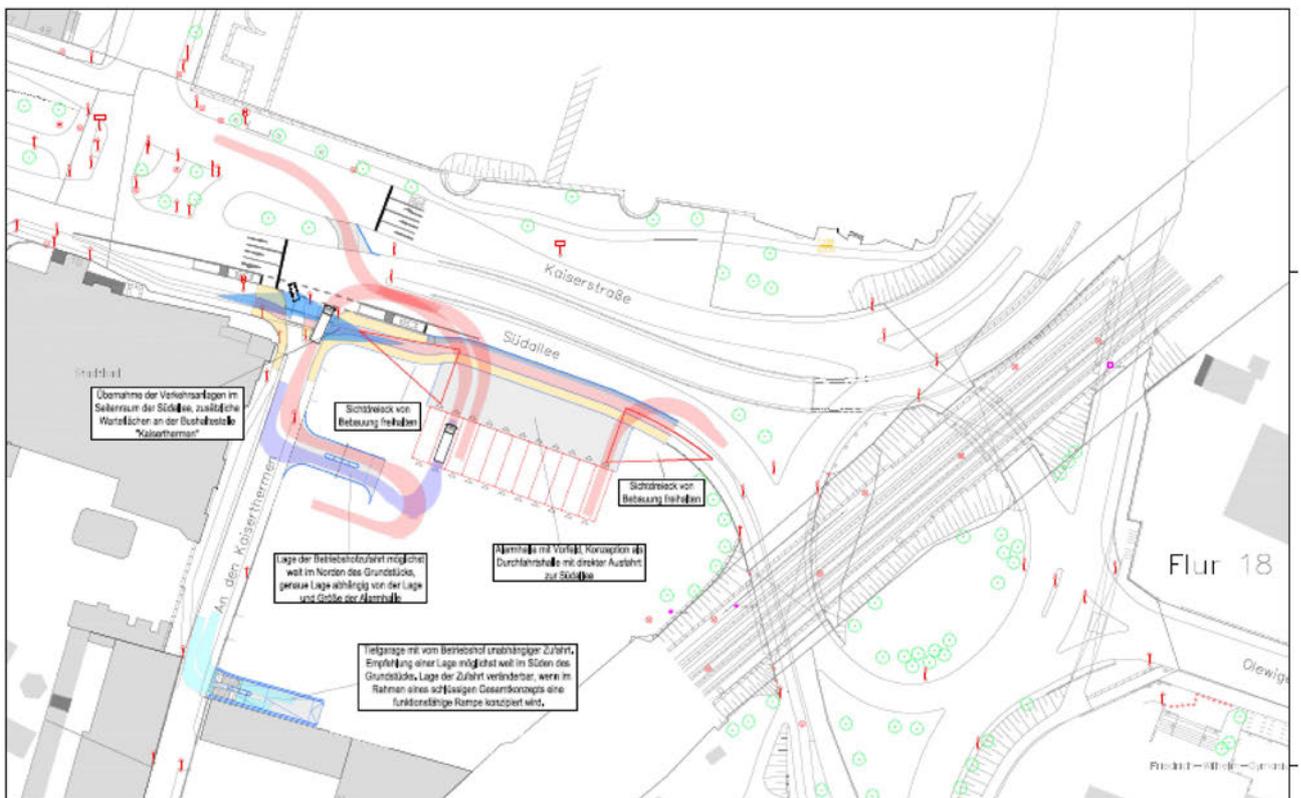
Verkehrsplan aus dem Verkehrsuntersuchung, Quelle R+T
